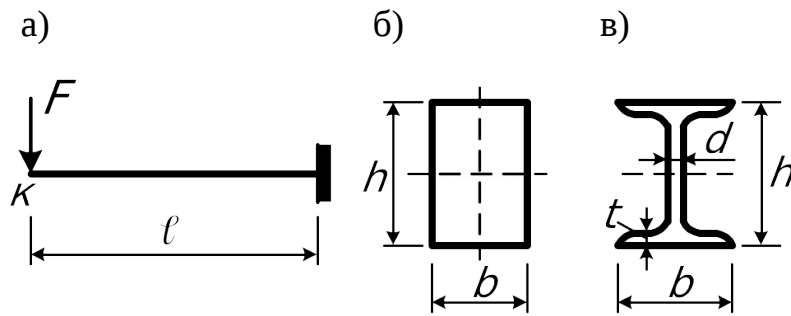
Розрахункова схема консольної балки (а) і схеми поперечних перерізів (б, в)
